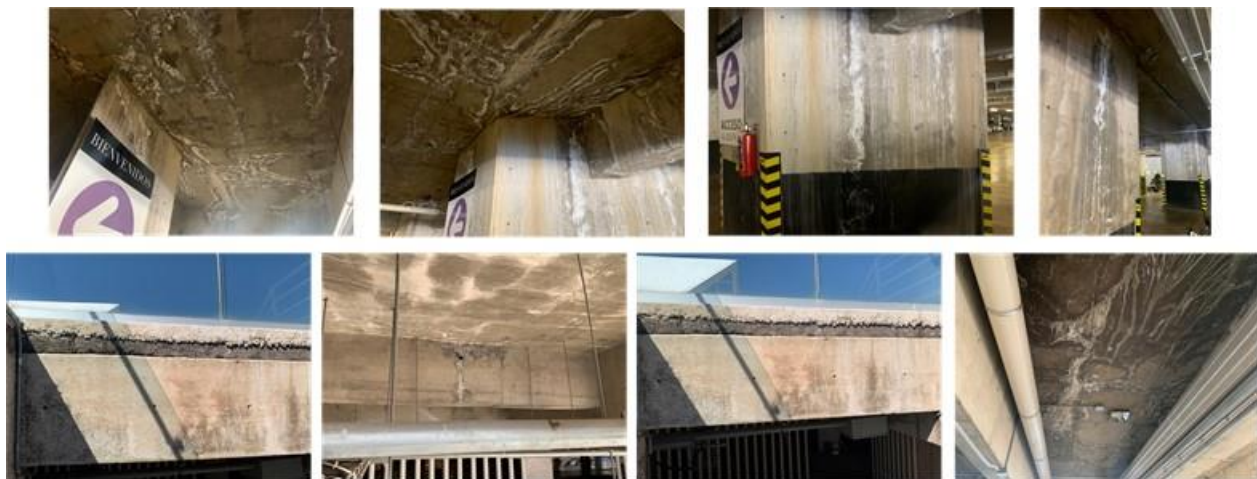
Patología de las grietas observadas en un edificio de estacionamiento que está en servicio desde el año 2012. Fotos tomadas por autor en abril 2024.
